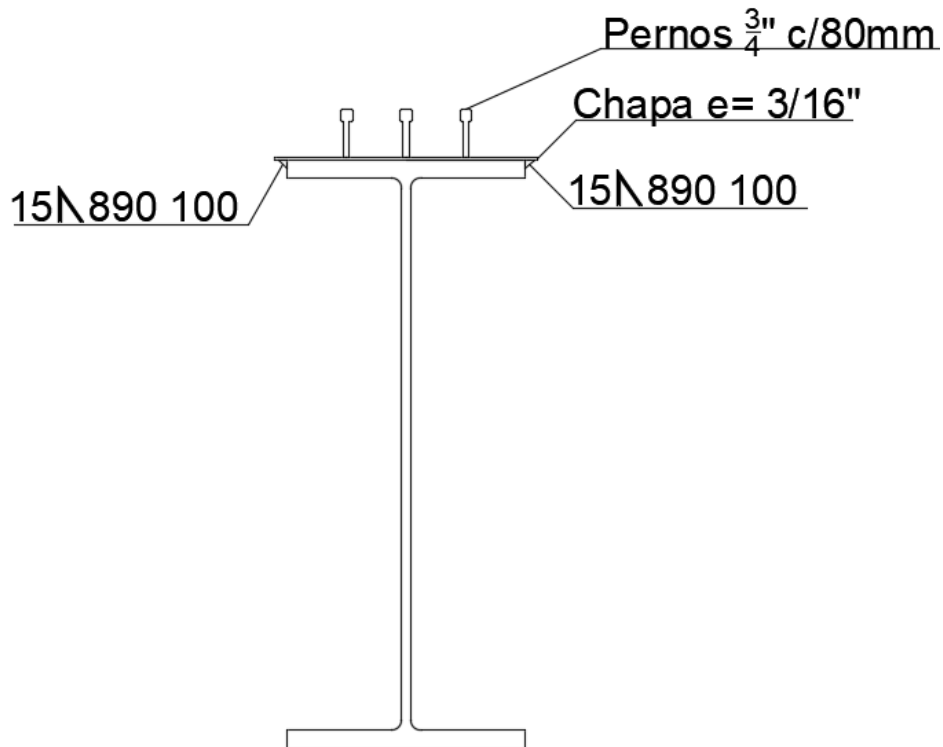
Detalle unión entre vigas longitudinales externas y losa del tablero con chapa soldada.
